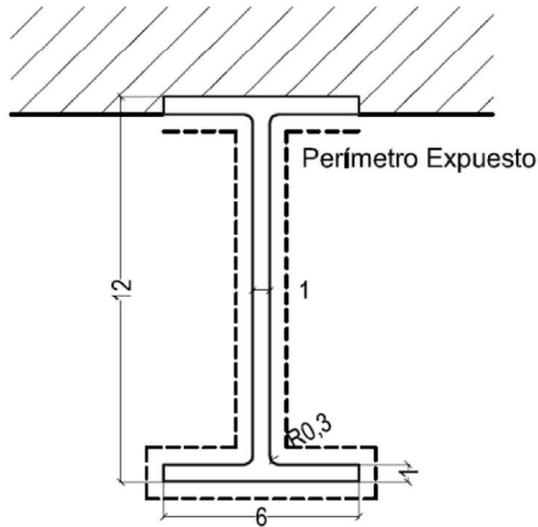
Viga “IPN120” del par de la cercha. Caras de la viga expuestas.
